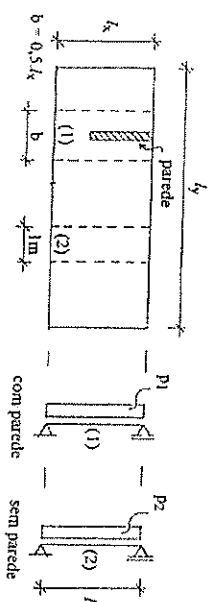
Laje armada em uma direção com parede na direção da armadura
